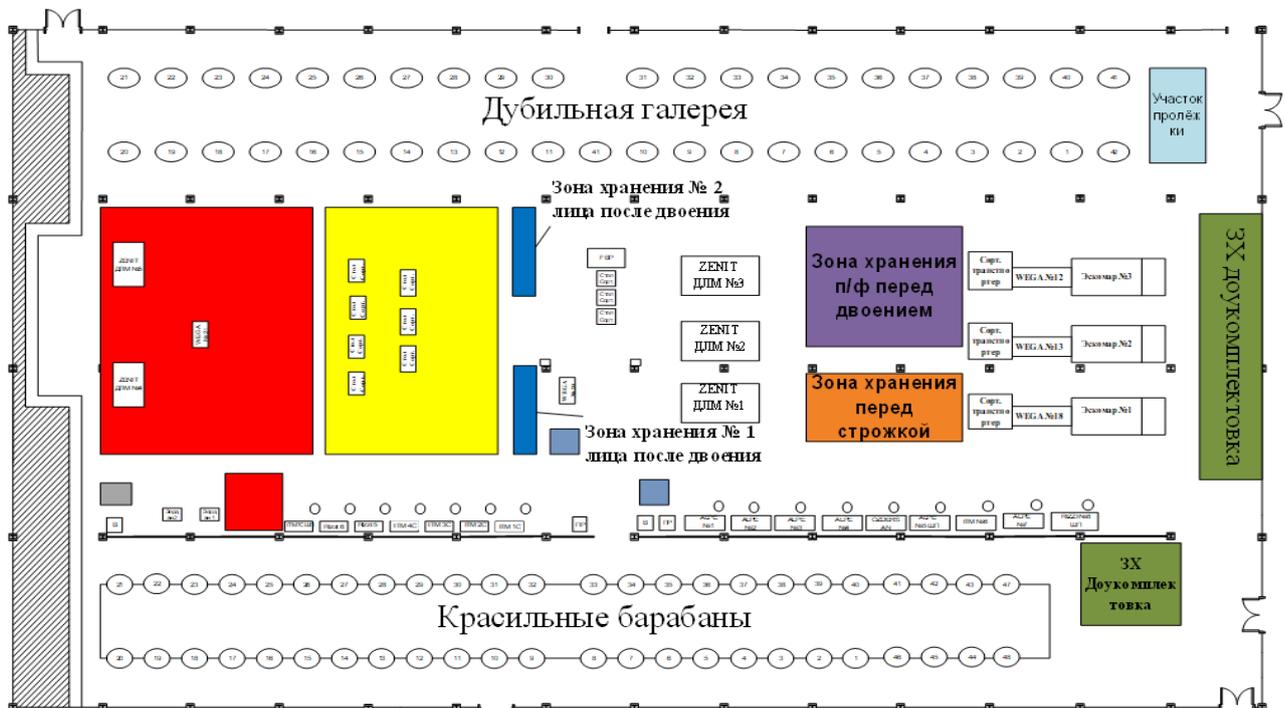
План цеха с оборудованием / Fig. 3. Plan of the workshop with equipment
